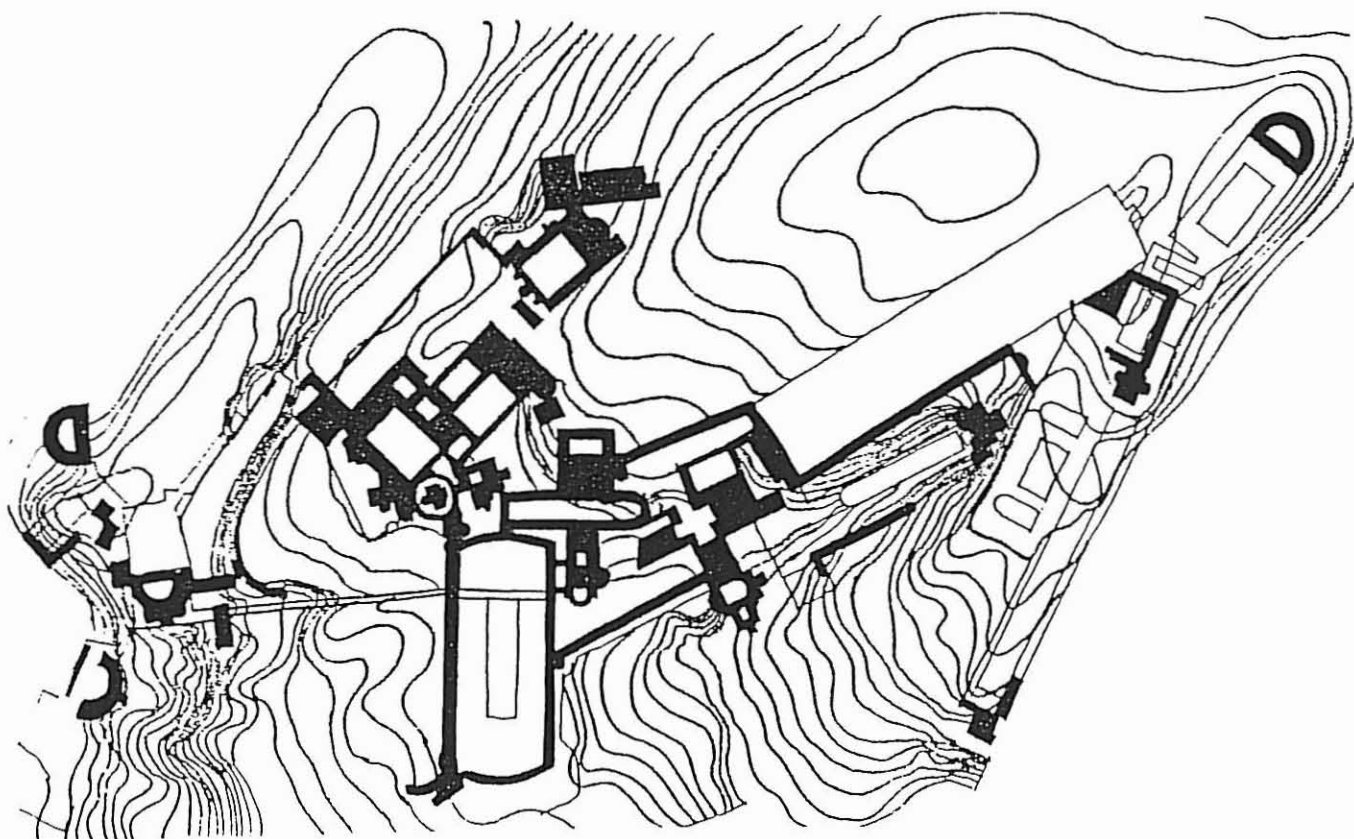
(LXVI) Plan topographique de la Villa d'Hadrien.
